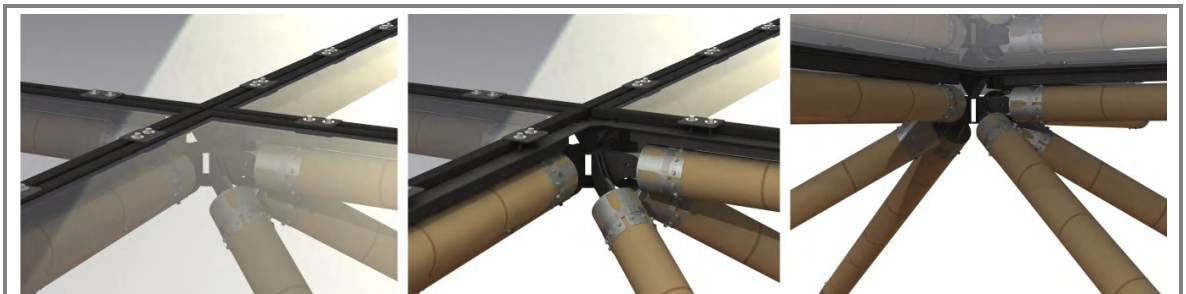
Sistema de cerramiento en vidrio tipo tornillo para fachada o cubierta
